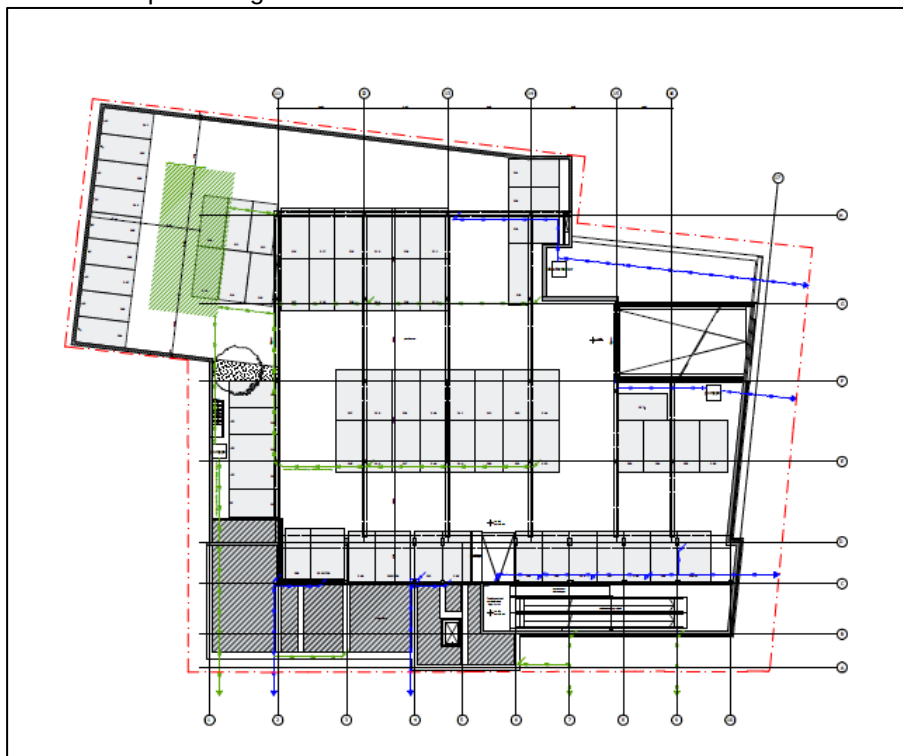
Uitsnede planvoornemen berekening waterbergingsopgave
